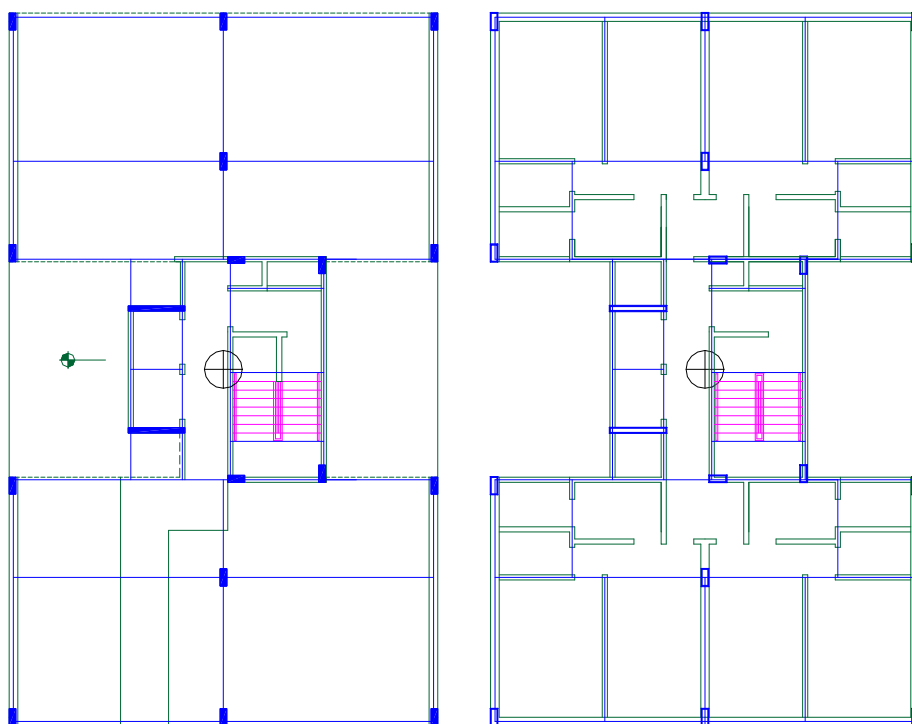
Edifício Exemplo: Formas estruturais para os Pavimentos Térreo e Tipo
